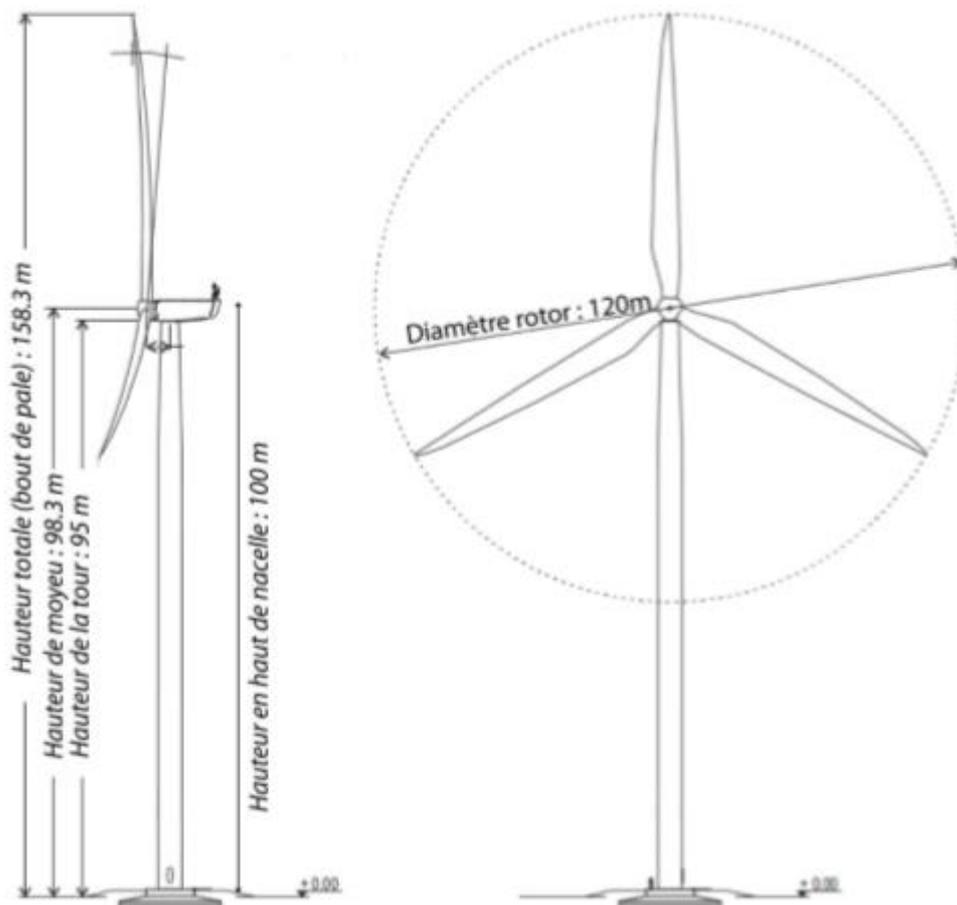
Plan d'élevation du gabarit-type d'éolienne prévu
